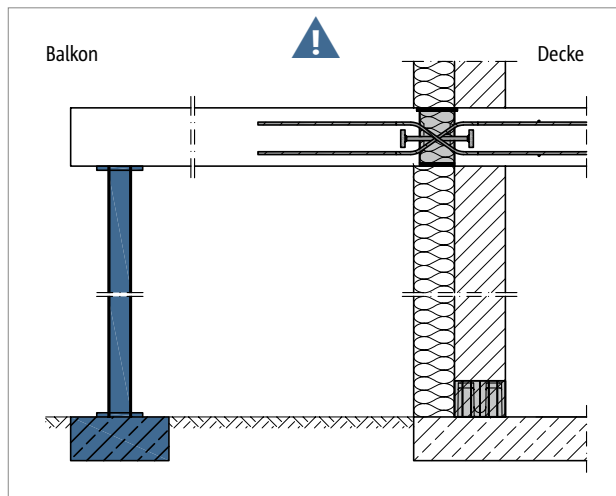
Schöck Isokorb® XT Typ QP-VV: Stützung durchgängig erforderlich
